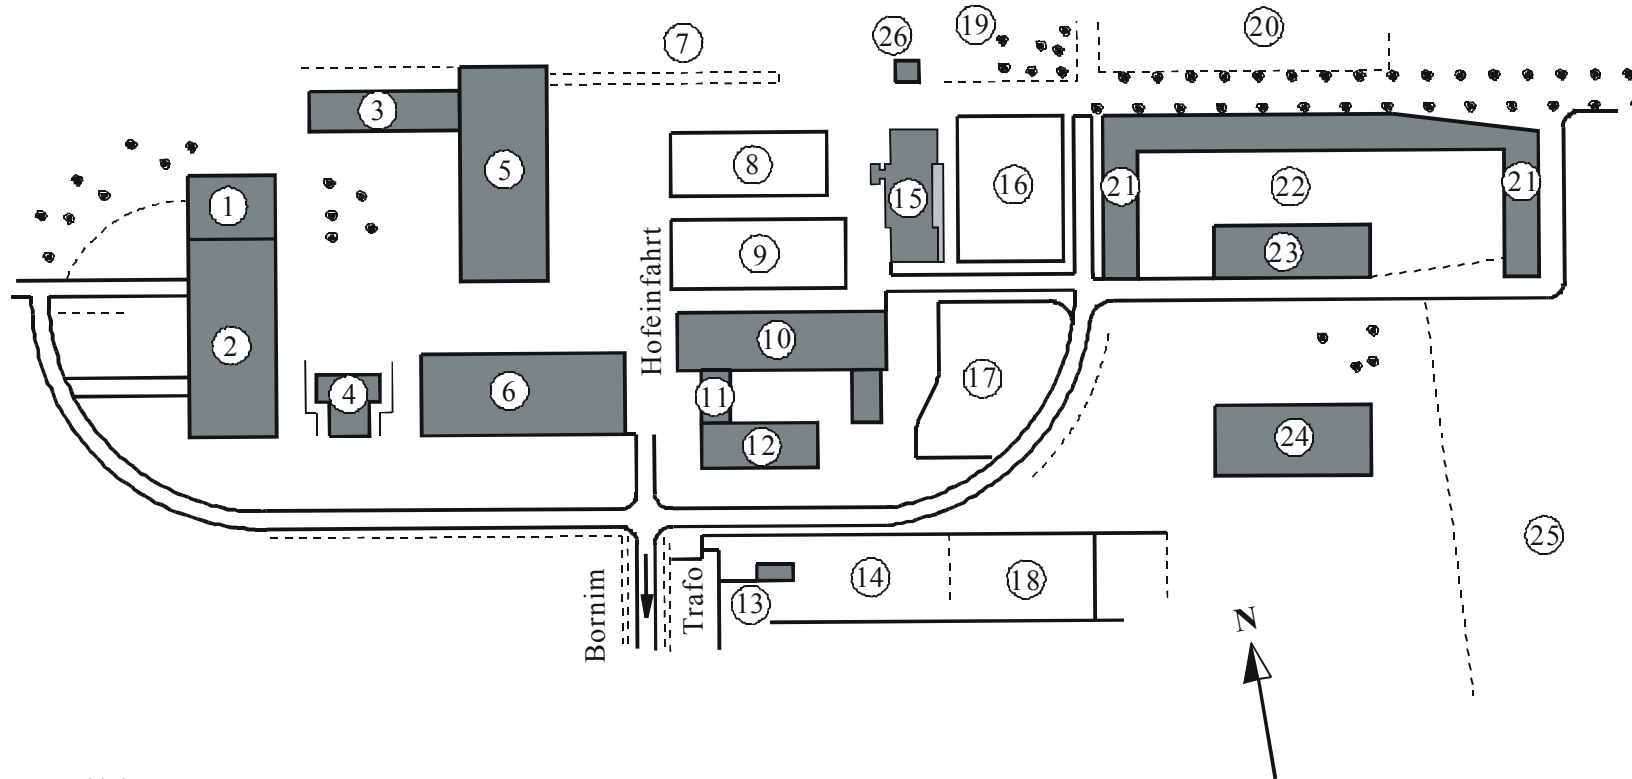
Lage und Bestand an Gebäuden auf dem Gutshof Bornim 1952
